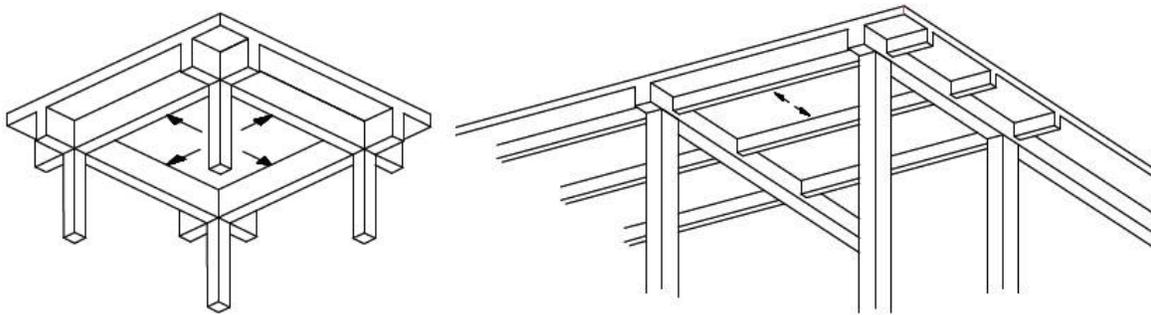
Marcos rígidos de concreto: Funcionamiento
